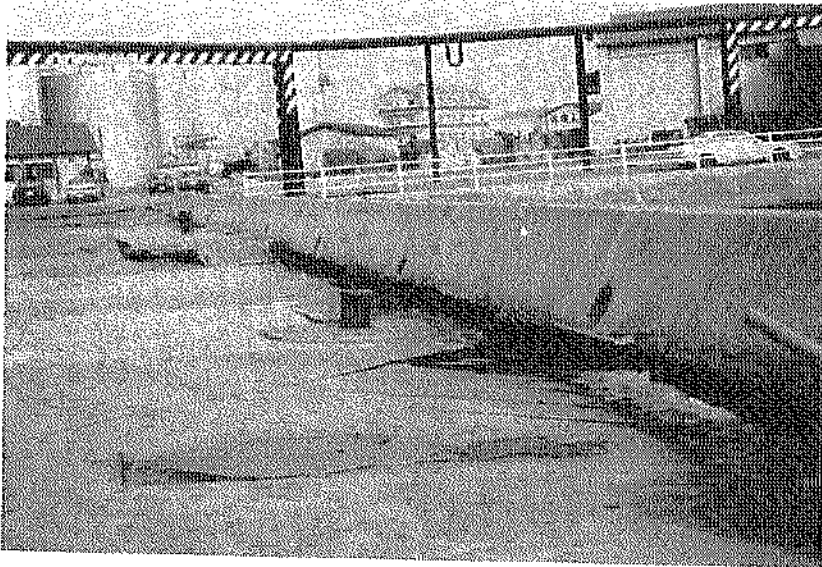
被災状況北埠頭，①物揚場(-2.8m)
